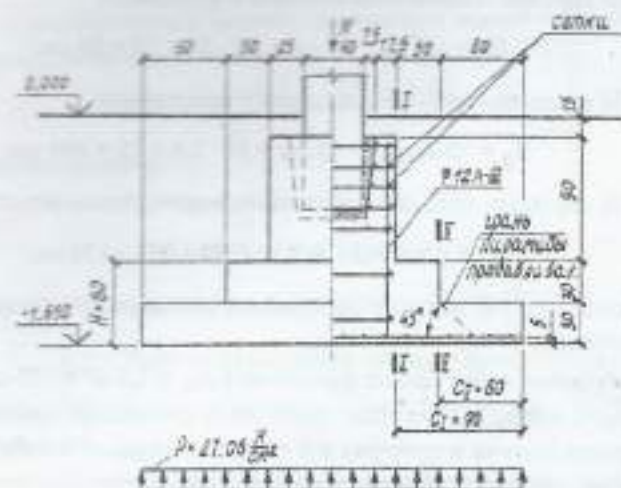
Конструкция фундамента под колонну каркаса по результатам расчета
